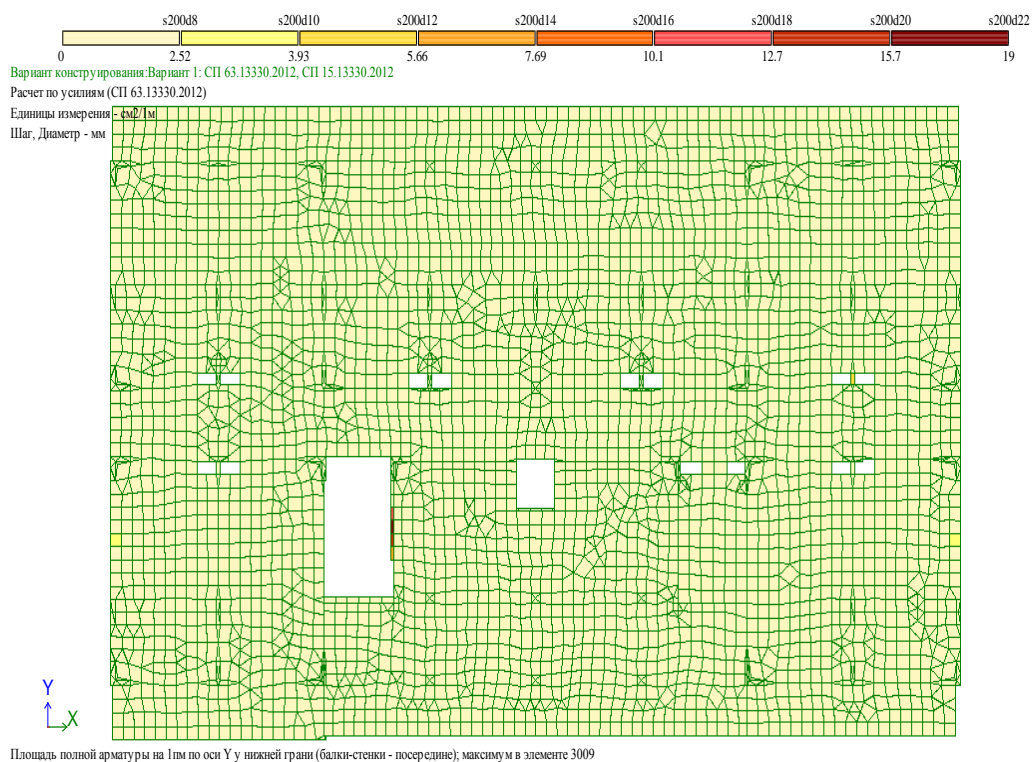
Армирование плиты перекрытия по оси Y ниже
